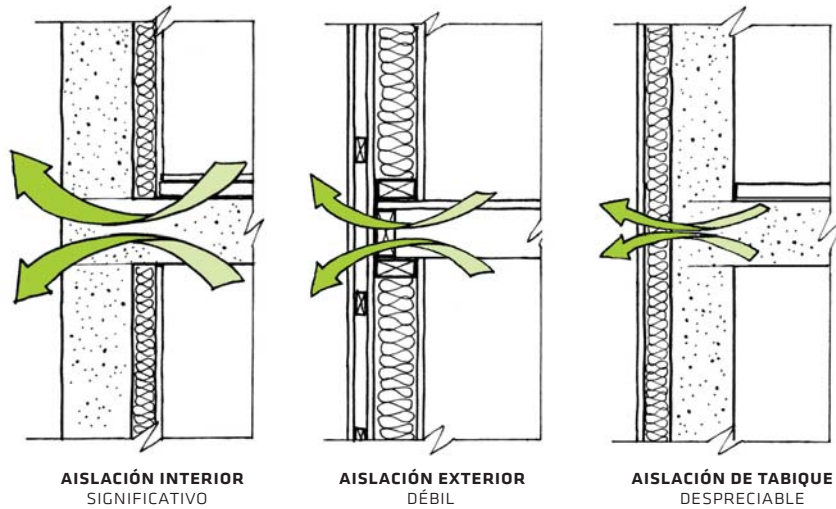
Puentes térmicos en encuentros de piso y muro. Aislación térmica interior: puente térmico significativo. Muro panel de madera: puente térmico débil. Aislación térmica exterior: puente térmico despreciable.
